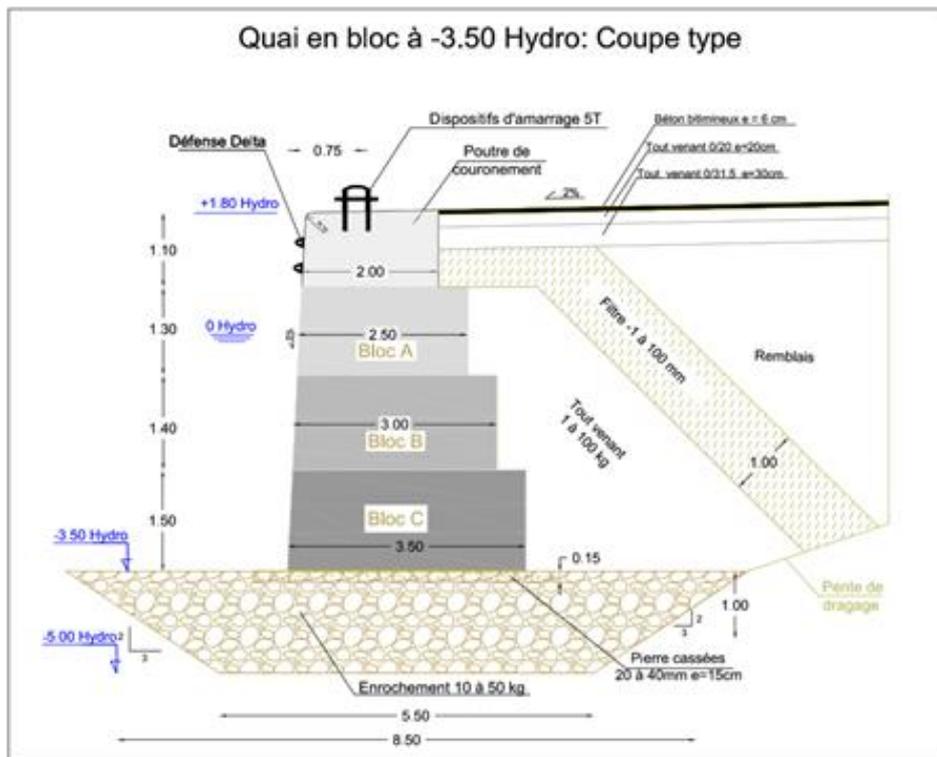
Coupe type d'un quai en bloc à -3.50 Hydro
